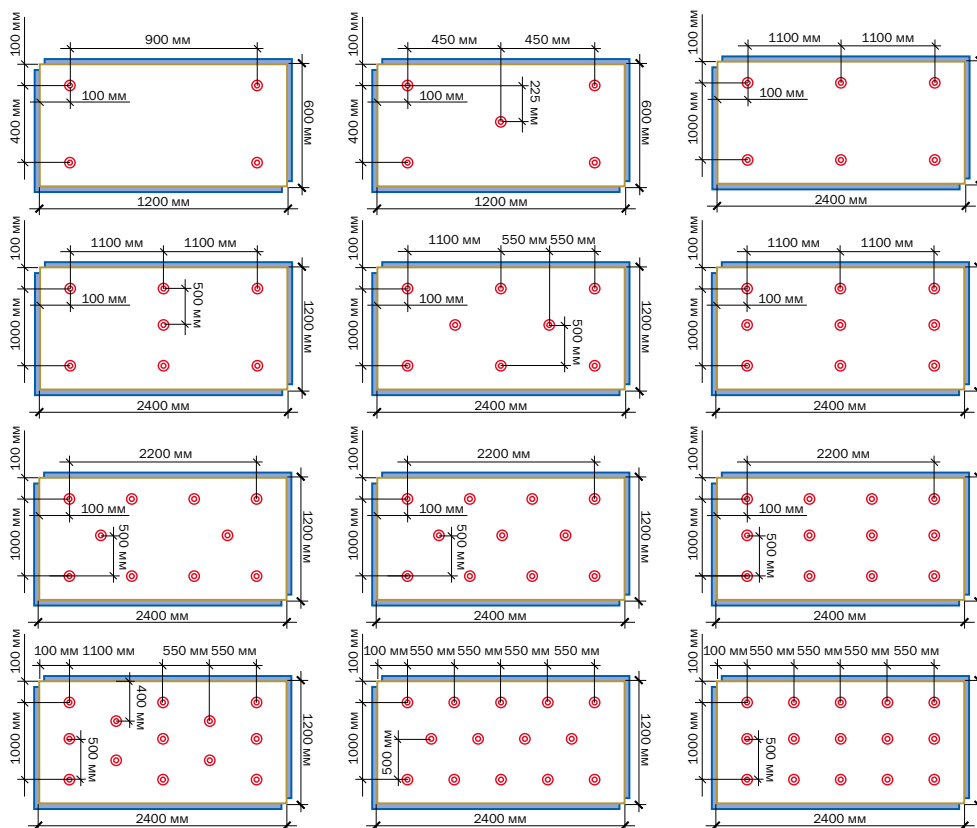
Схема крепления теплоизоляционных плит из пенополиизоцианурата
